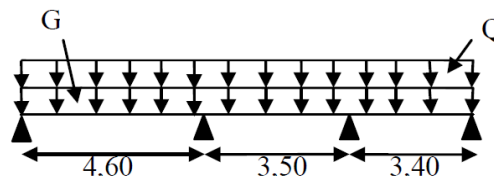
Schéma statique de la poutrelle T5 (plancher d'étage courant (1))
